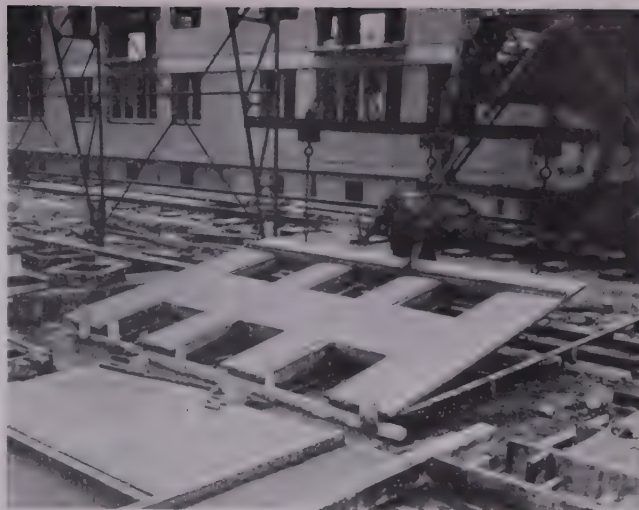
Début de levage d'une plaque (Photo Moignard, Rouen).
